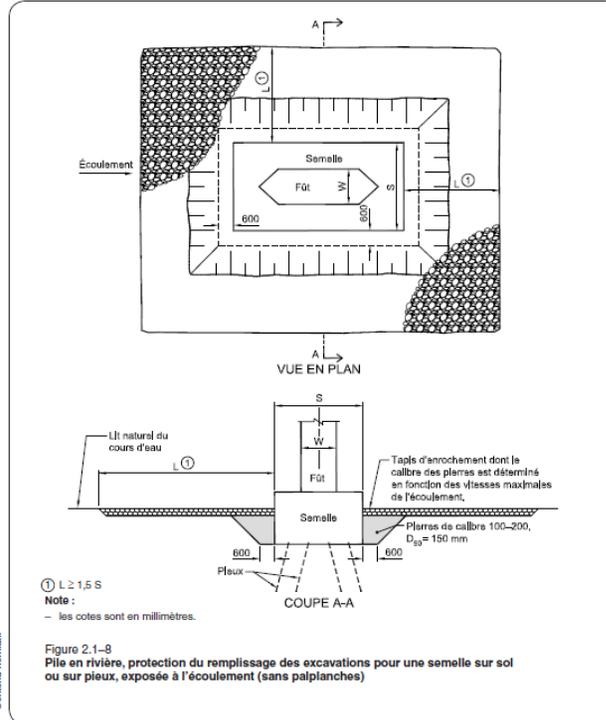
Schéma d'encrochement des semelles en forme de tapis prévu autour des semelles des piles 4, 5, 7, 8, 9, 10 et 11 du pont Charles-De Gaulle (Collections Normes - Ouvrages routiers du MTQ, Tome III - Ouvrages d'art, Chapitre 2 - Conception des ouvrages d'art, p.13)
